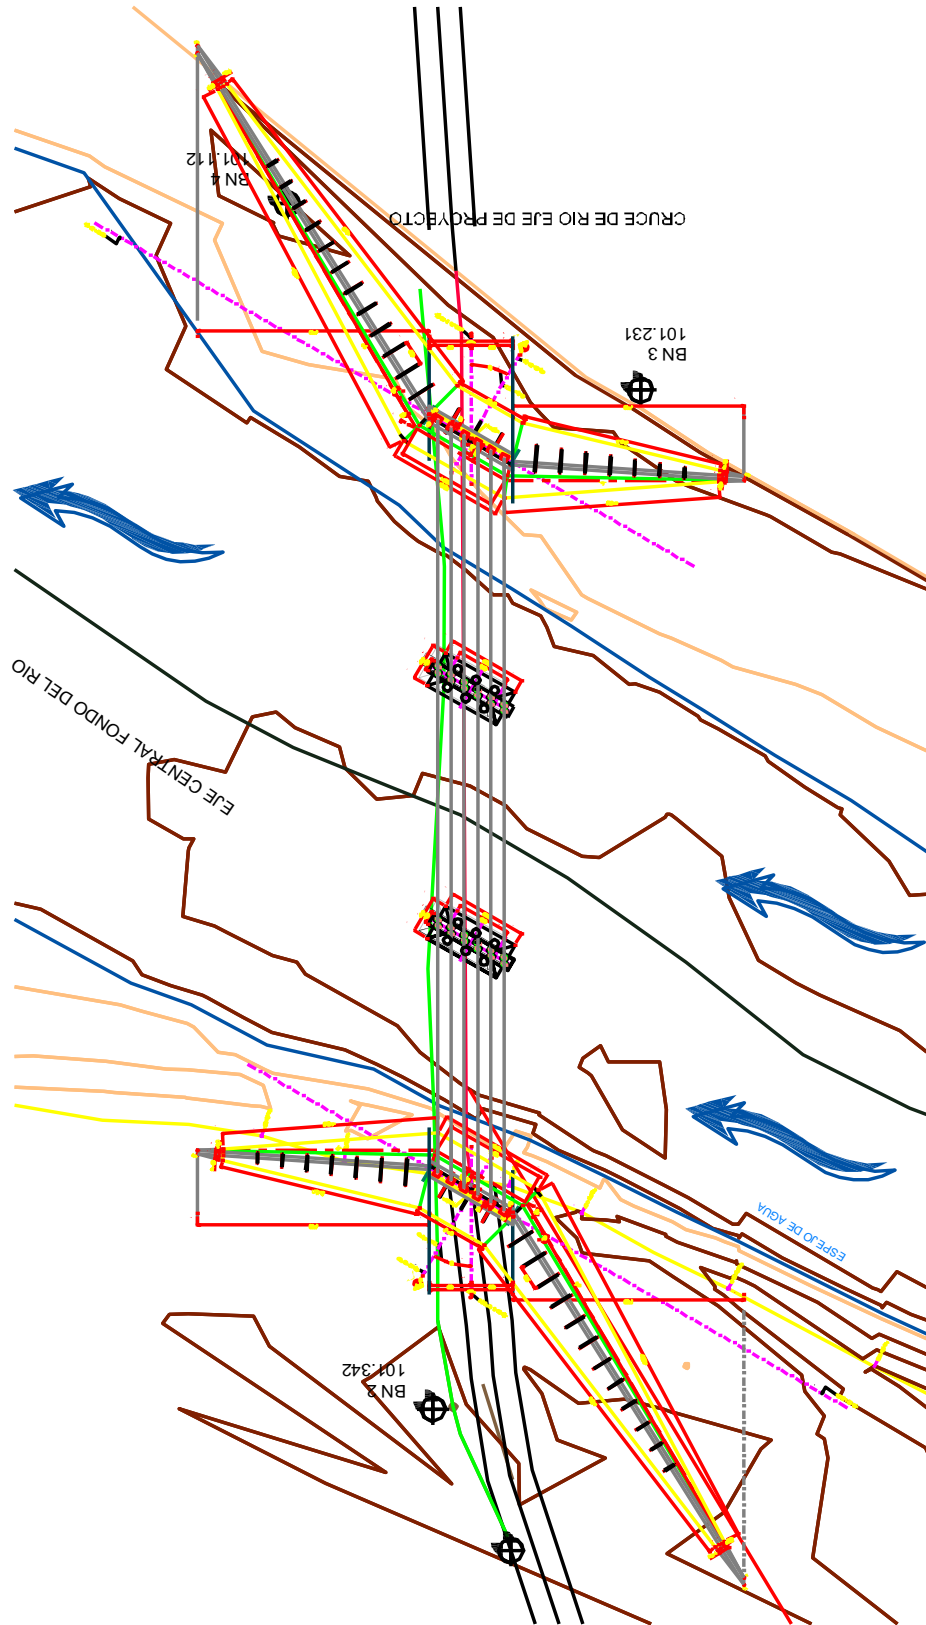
Vista en planta del puente tipo Tres Marías- Nuevo Palantla
